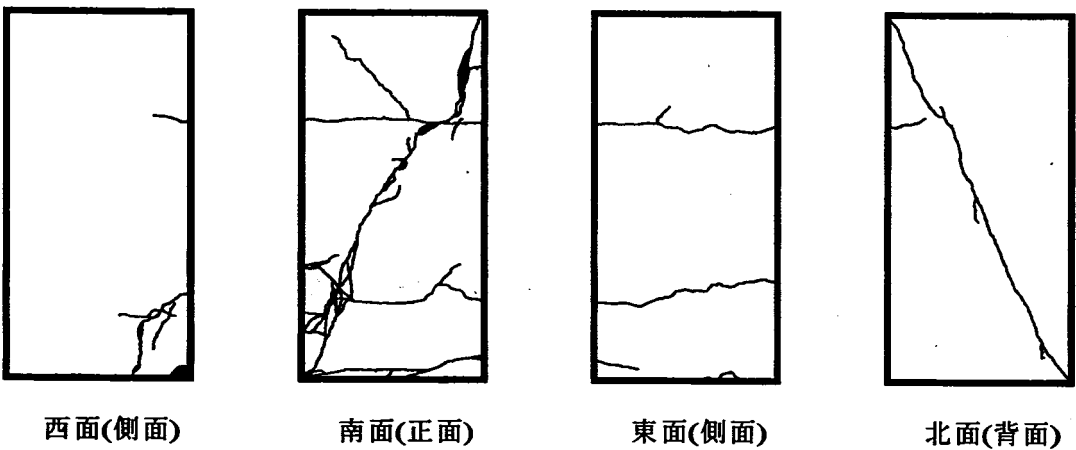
CS-36A40 (石炭灰 40%コンクリート) のひび割れの進展および破壊性状
